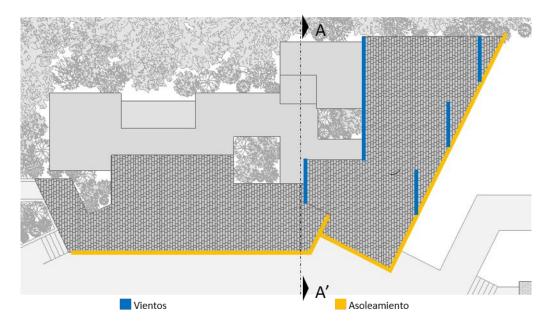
Líneas de composición en la planta de cubiertas Fuente: Elaboración propia
